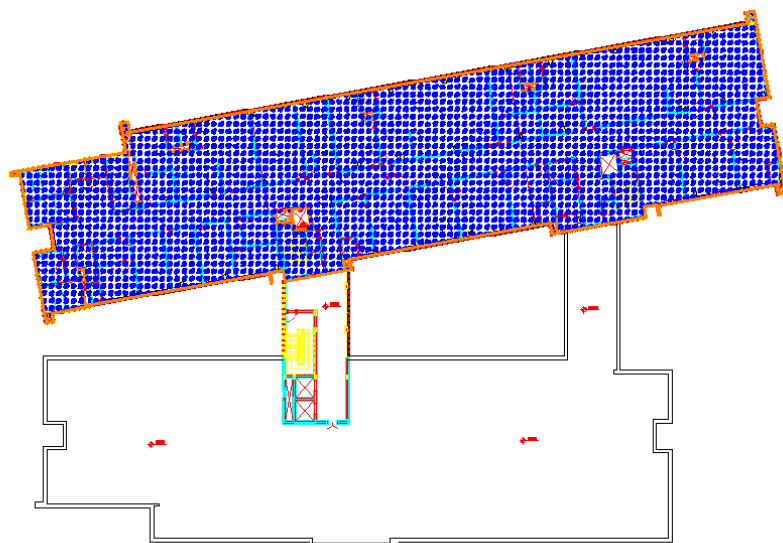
Área considerada para pavimento tipo (5º Pavimento)
